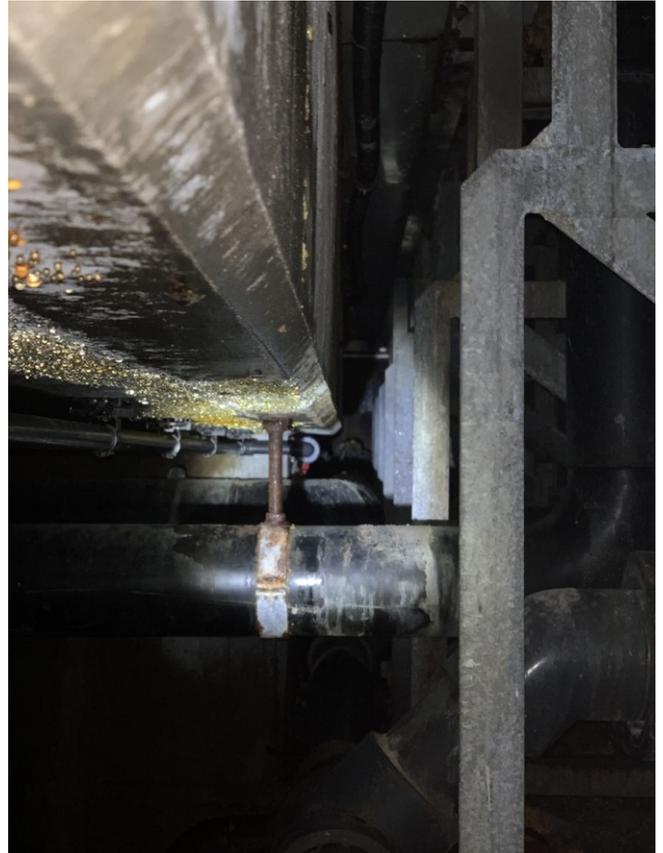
gänzlich unzugängliche Bereiche mit korrodierendem Becken und Tragkonstruktion
